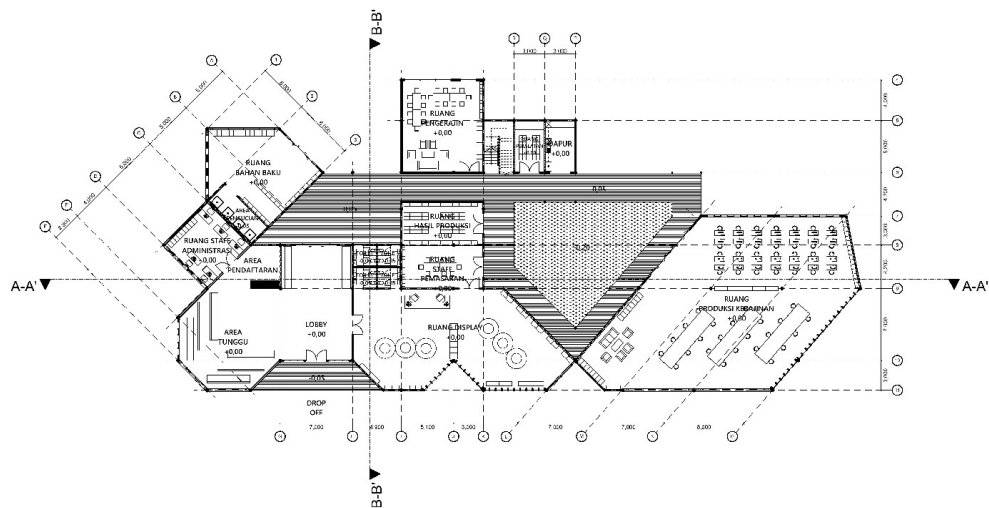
Siteplan Pusat Kerajinan Cendera Mata
